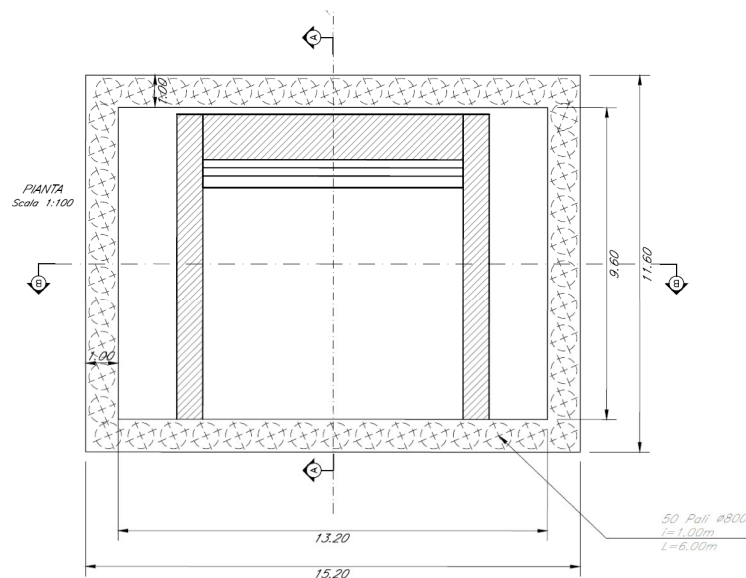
Pianta pozzo di fondazione costituito da coronella rettangolare di pali D800 interasse $i=1.00$ m
